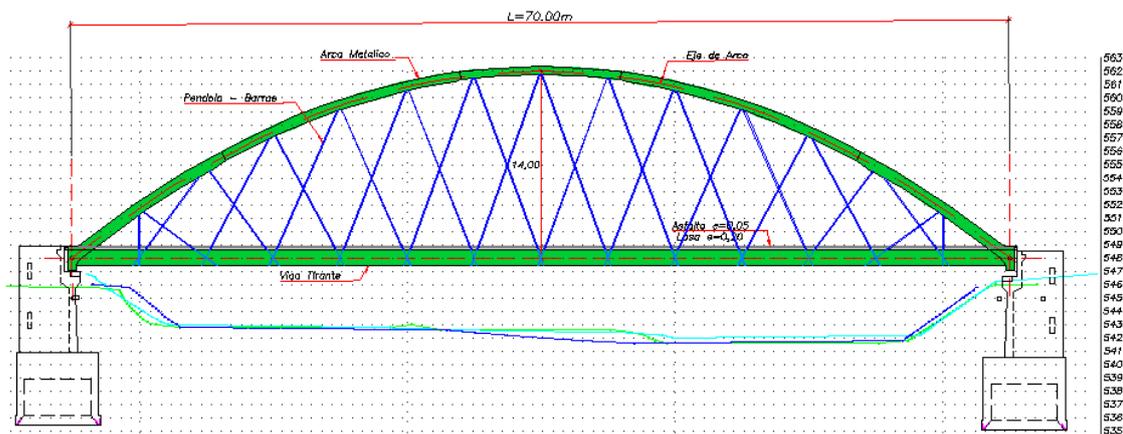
Vista en elevación del Puente Ñaña. (Fuente: AutoCAD, 2018)
